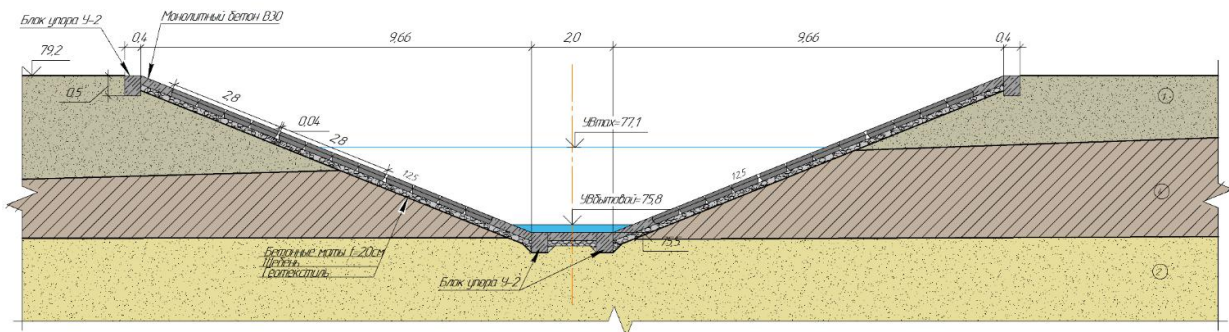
Комбинированное крепление гибкими бетонными матами и железобетоном
